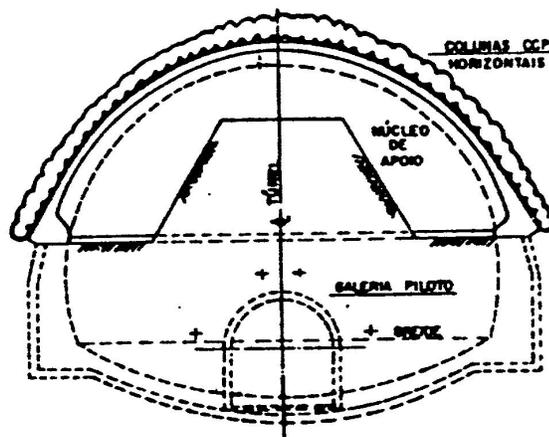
Seção Pré - Suportada com Jet Grouting Horizontal, e Túnel Piloto Escavado abaixo da Calota ( Túneis Viários de São Paulo )
